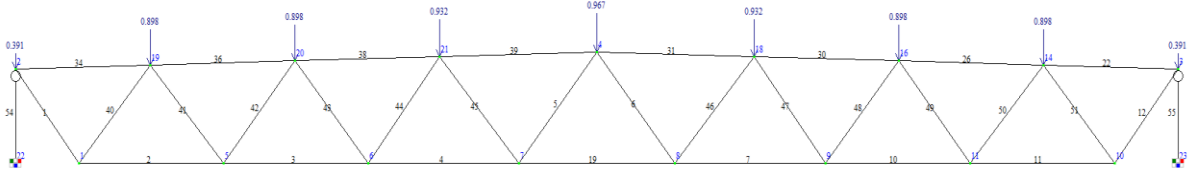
Загрузка 2, Нагрузка от веса покрытия
